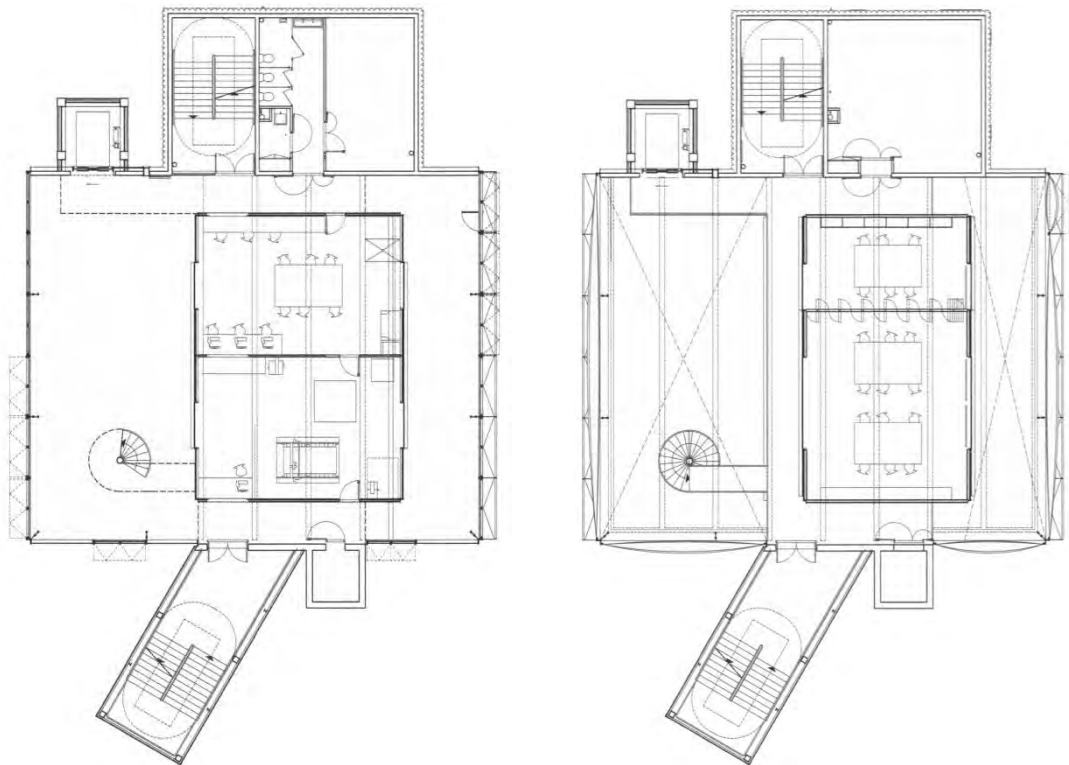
Planta segunda y entreplanta de Le Dôme, 2013-2015
